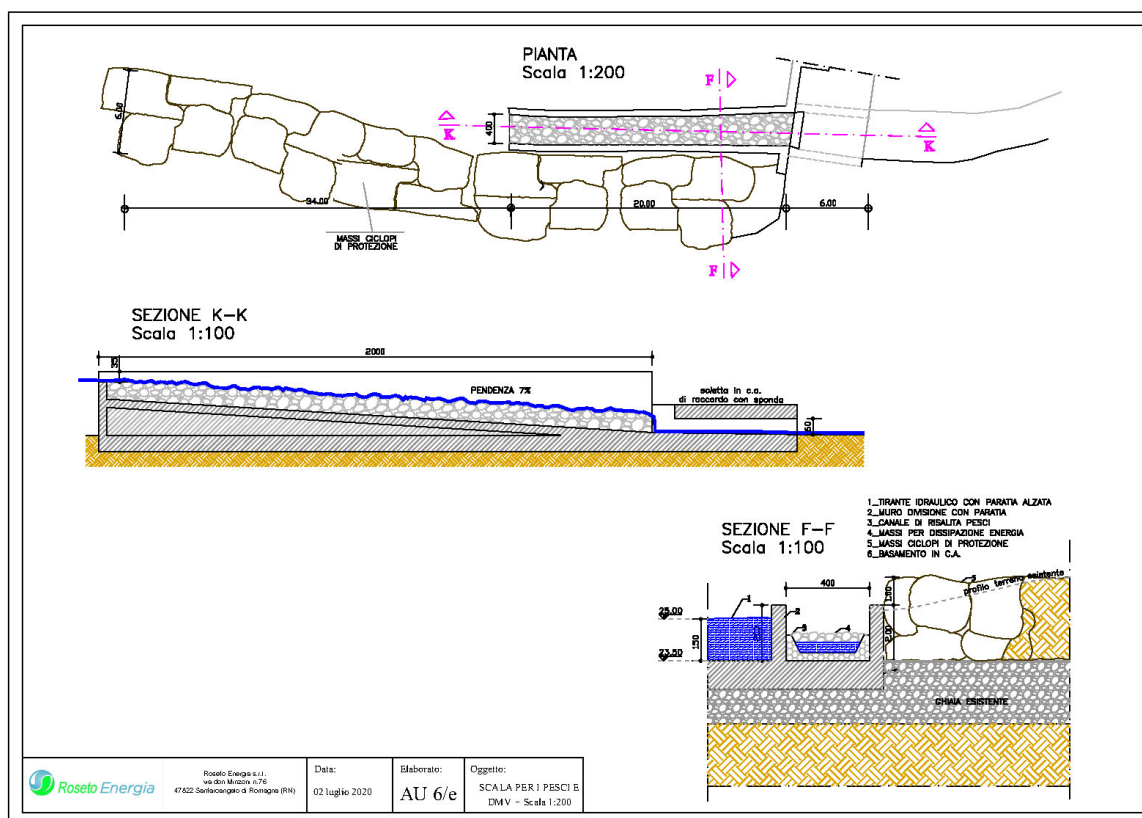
Elaborato AU/e aggiornato (Allegato 1)
